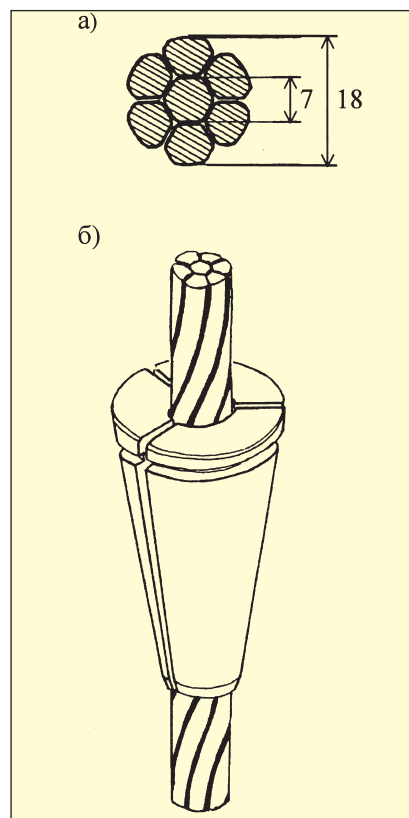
Сечение стренда (а) и внешний вид охватывающей его цапги (б)
